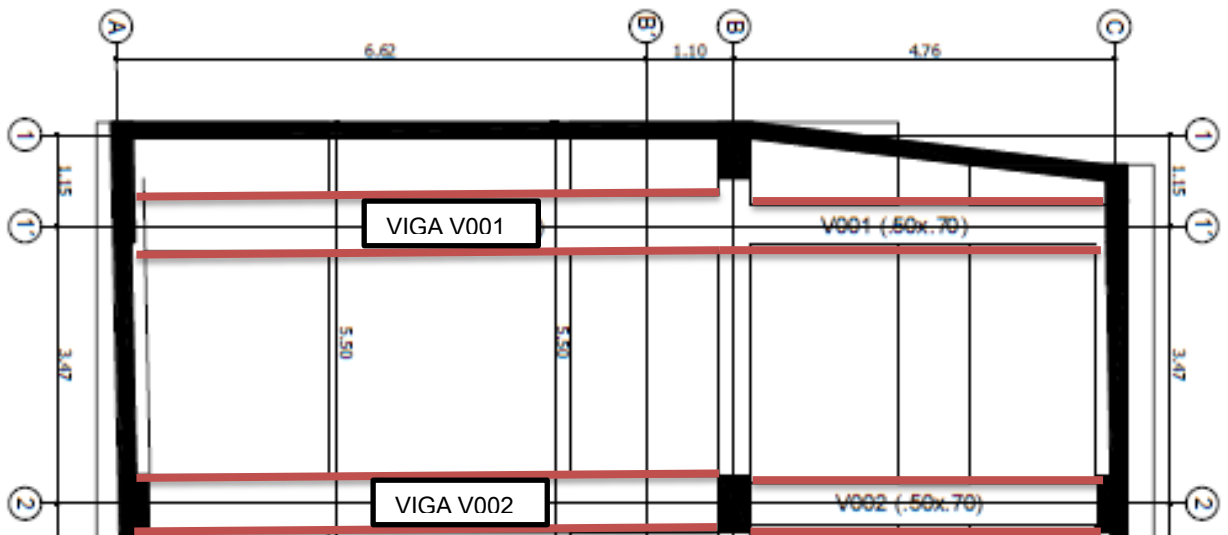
Ubicación de las vigas V001 y V002 en el sótano del proyecto N-3.0
